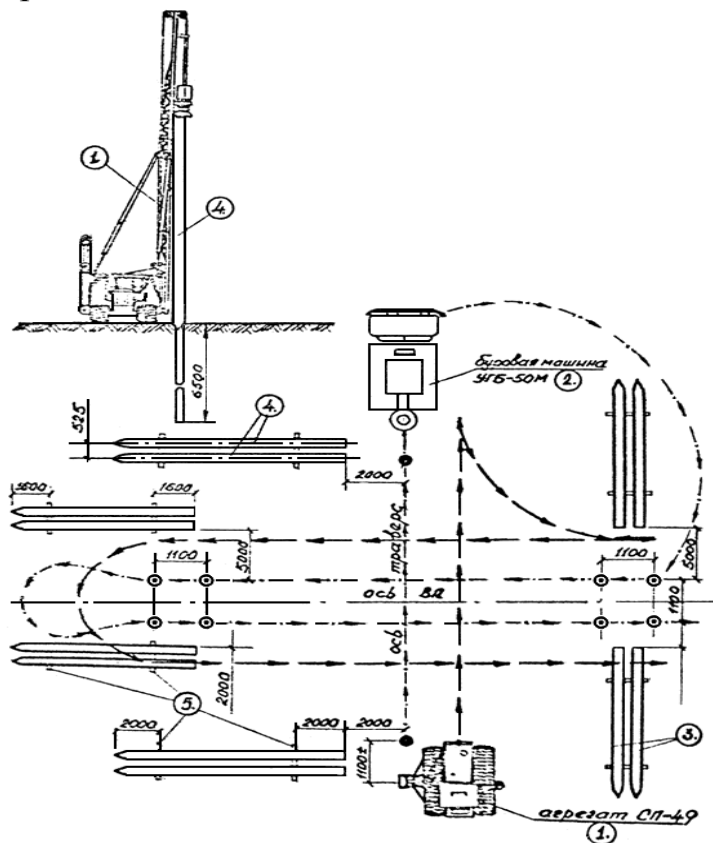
Схема движения бур. станка УГБ-50М и сваебойного агрегата PVE-5021
